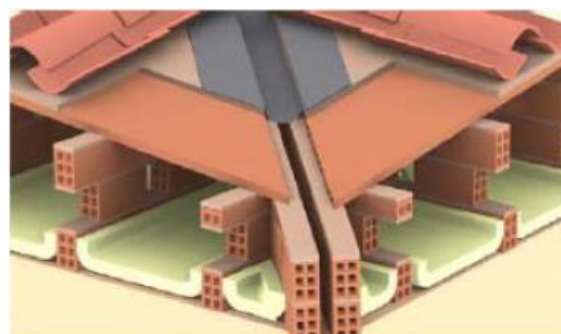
Aislamiento de cubierta entre tabiquillos.
